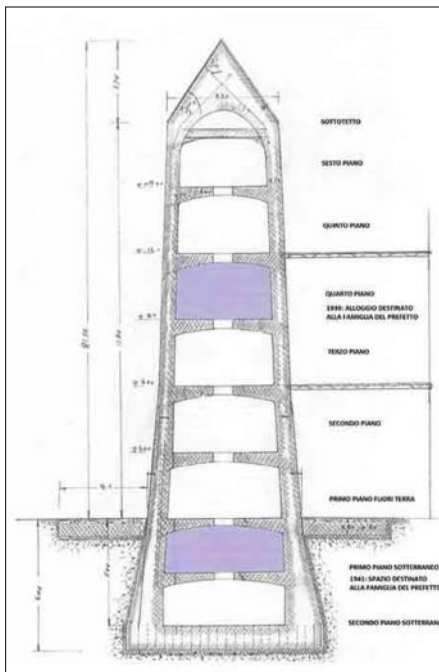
Pianta e sezioni di alcuni piani (rilievo dell'Ass.ne S.C.A.M. - F.N.C.A.).
